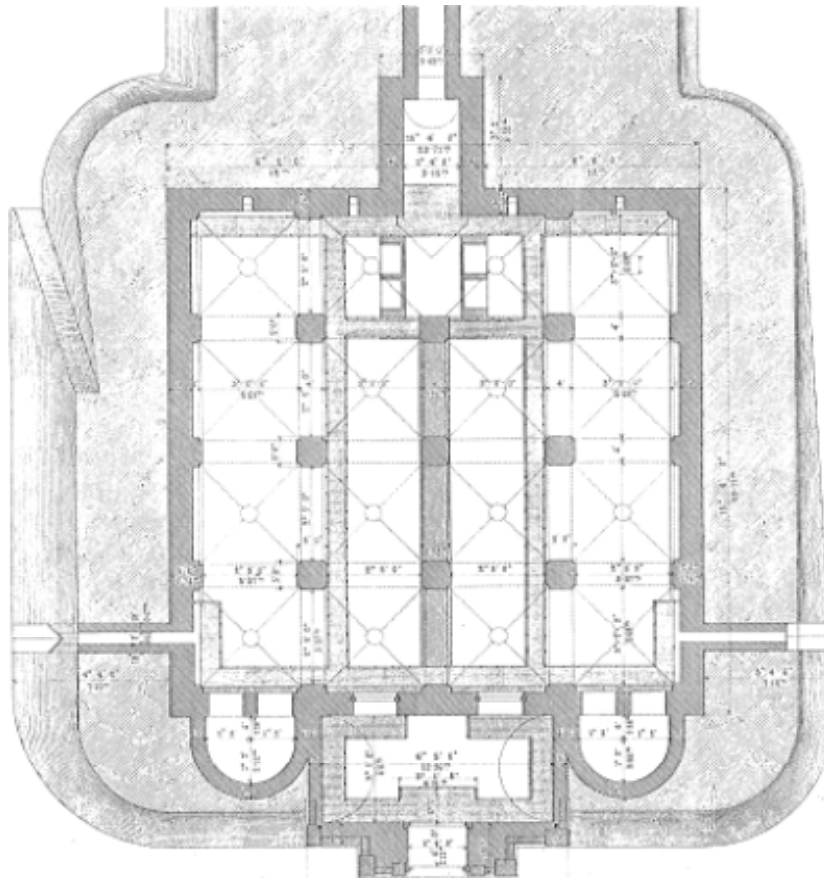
Grundriss der Speicherkammer des Wasserbehälters auf dem Rosenhügel
